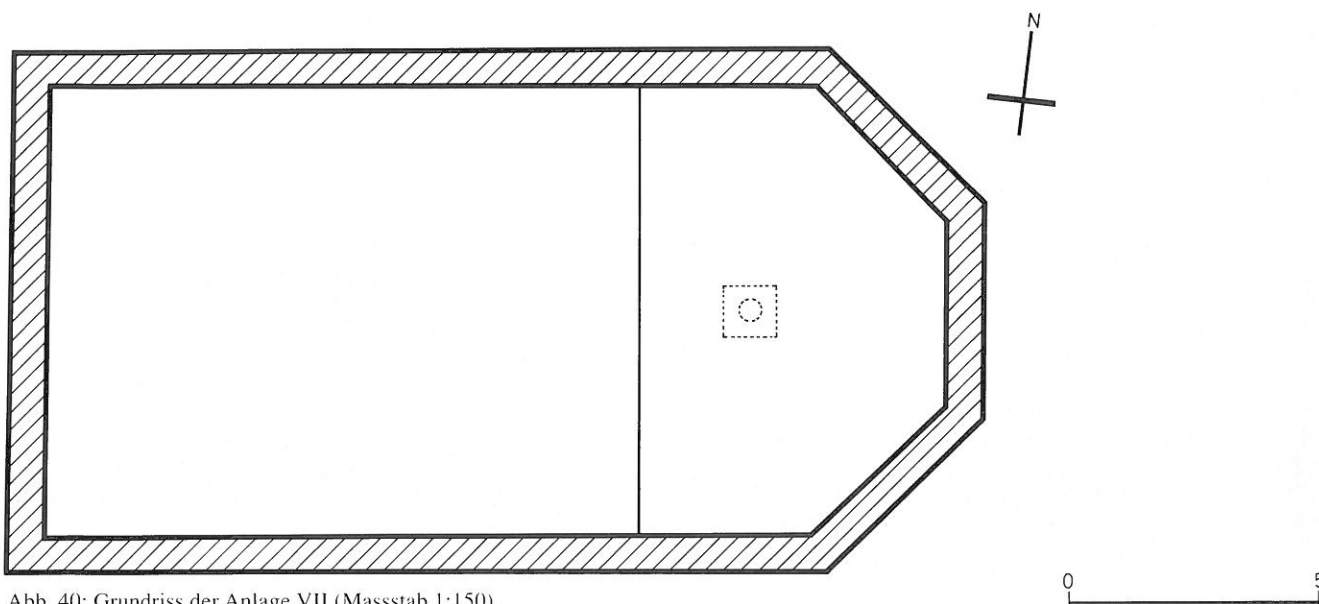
Grundriss der Anlage VII (Massstab 1:150).
